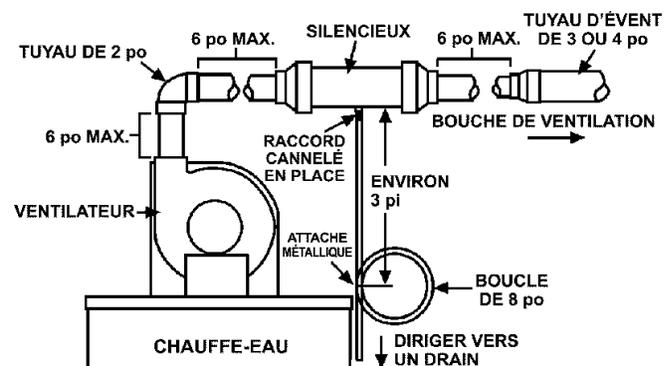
Installation horizontale type dans un système constitué d'un tuyau de 3 ou 4 po
